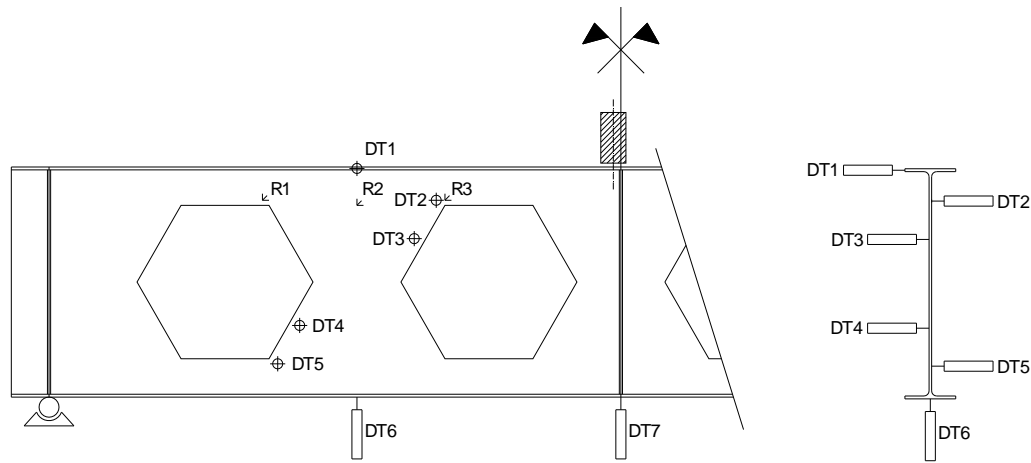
Projeto de instrumentação para as vigas do grupo A.
